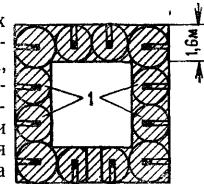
Обрушение башни на месте путем подрывания всех стен шпуровыми зарядами:
